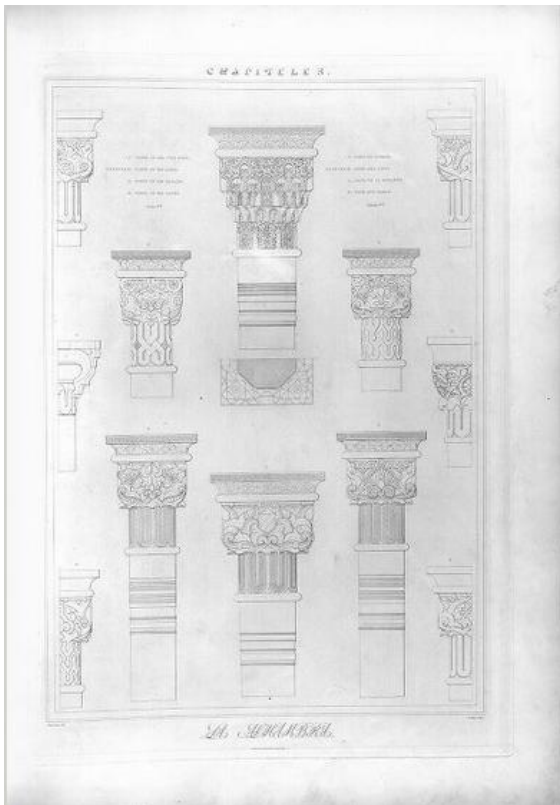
Capiteles. Owen Jones (ca.1834) Plans and elevations, sections and details of the Alhambra (1836). Vol.I. Plate XXXIV.
